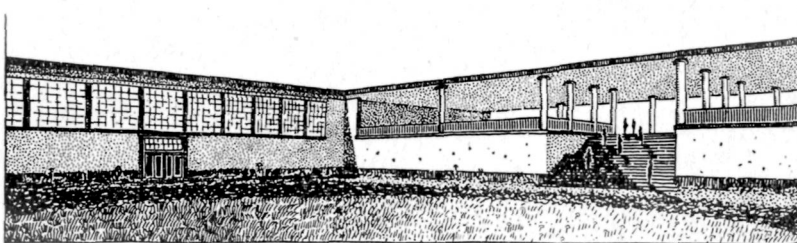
Ausstellungsanlage Berlin. Blick in einen Ausstellungshof¹⁾
